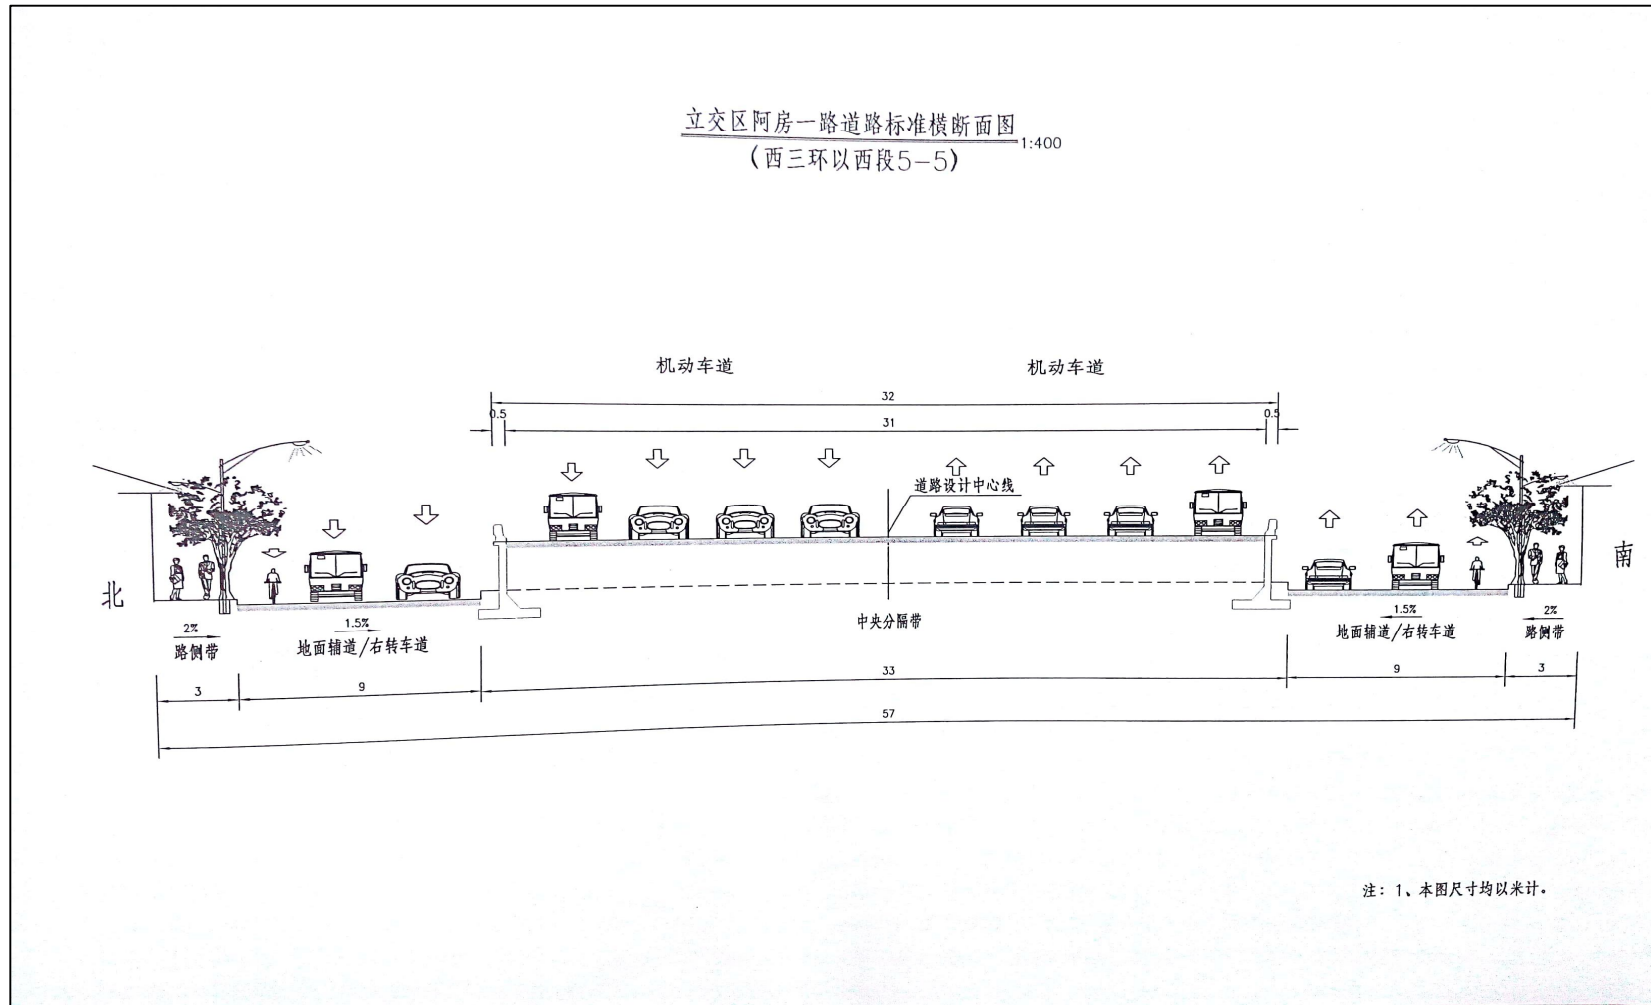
立交区阿房一路(西三环以西)道路横断面示意图
